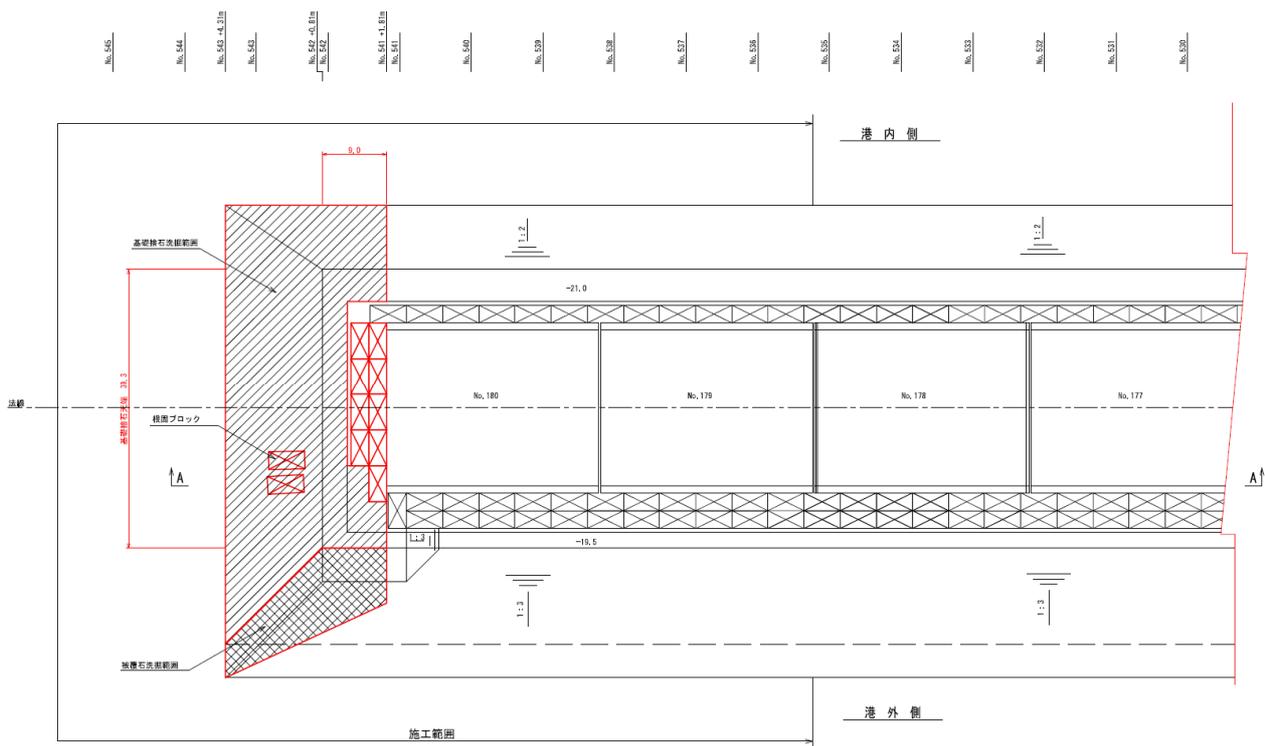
24 No.2 常陸那珂港区_東防波堤平面図 (被災後)
